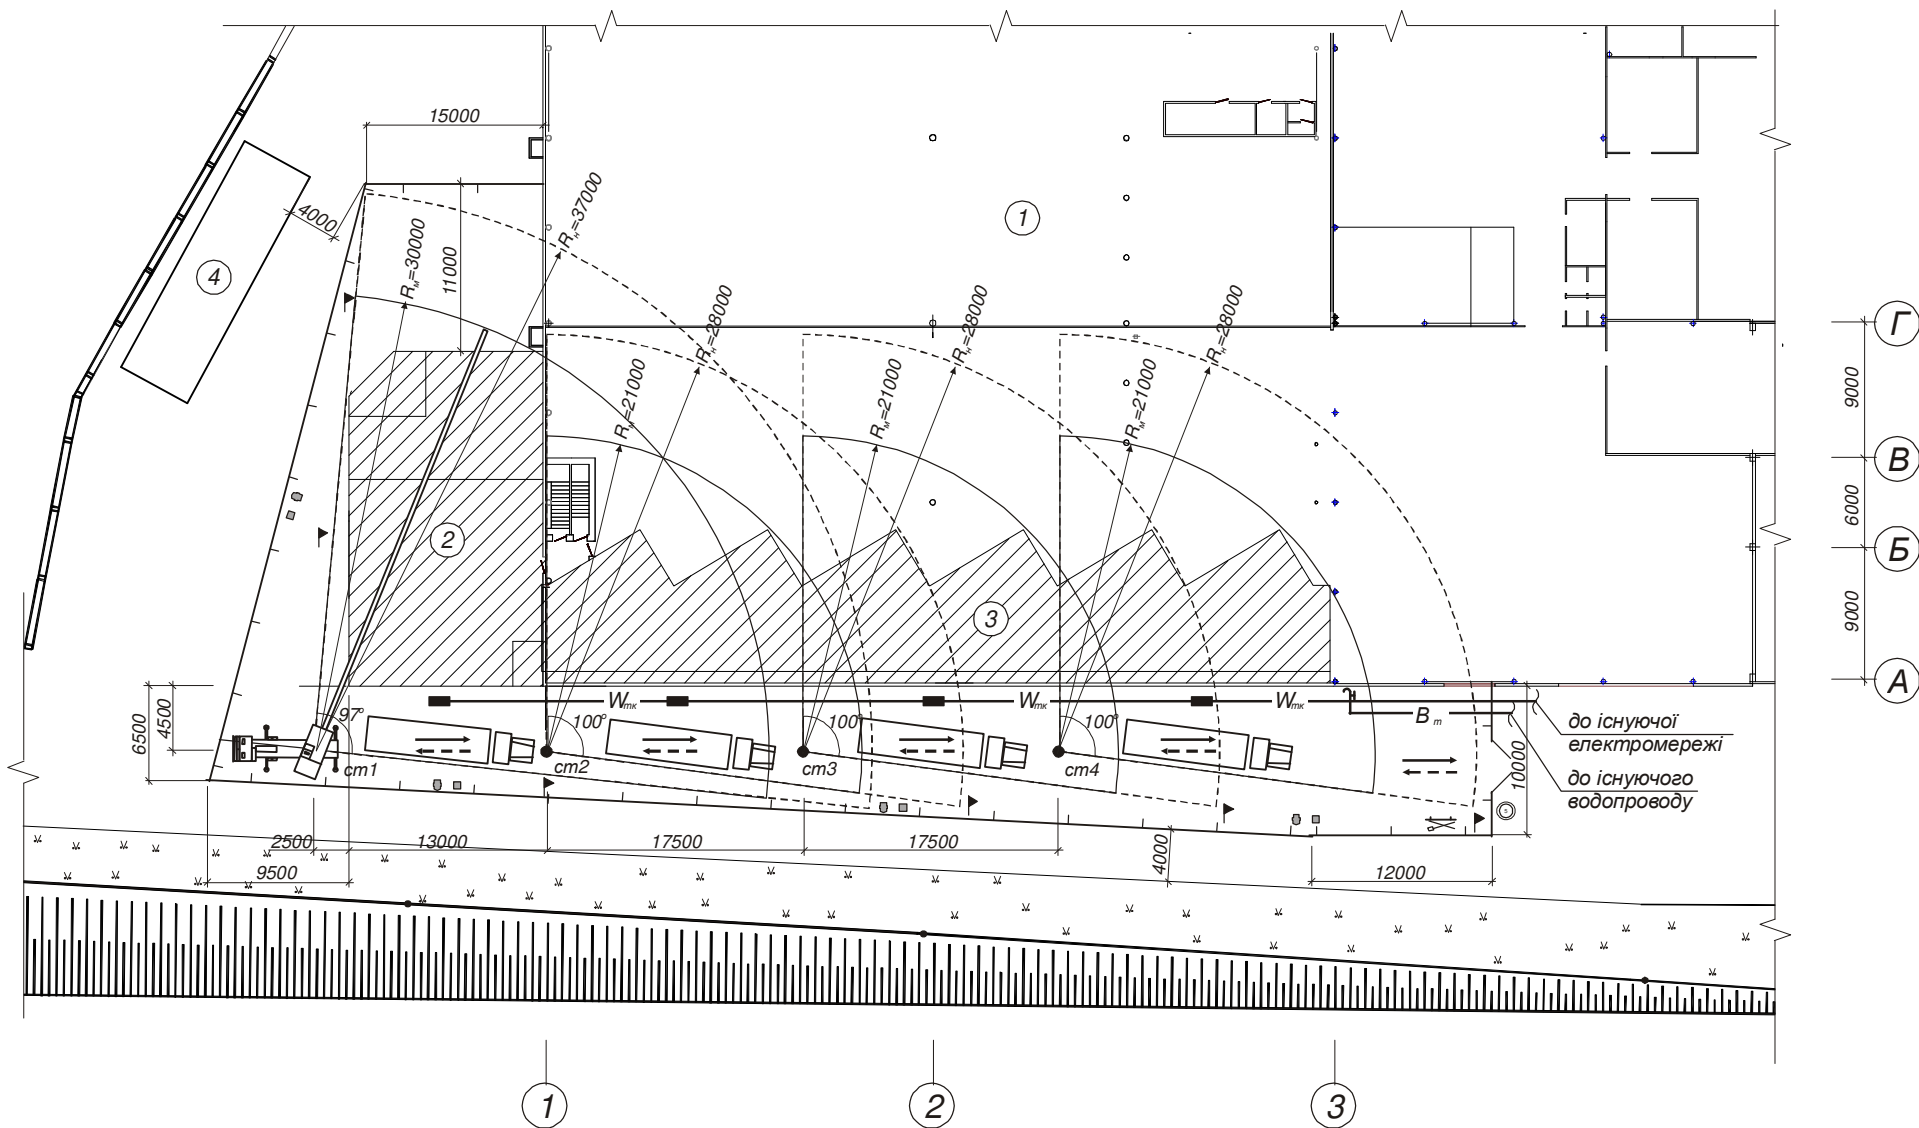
Будівельний генеральний план реконструкції виробничої будівлі кондитерської фабрики «Домінік»
